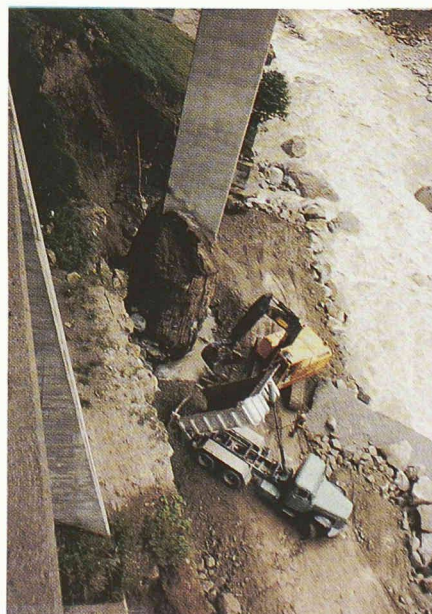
La pile J et la Reuss, refoulement de la Reuss. (Photo: T. R. Schneider, 1878/11.)
